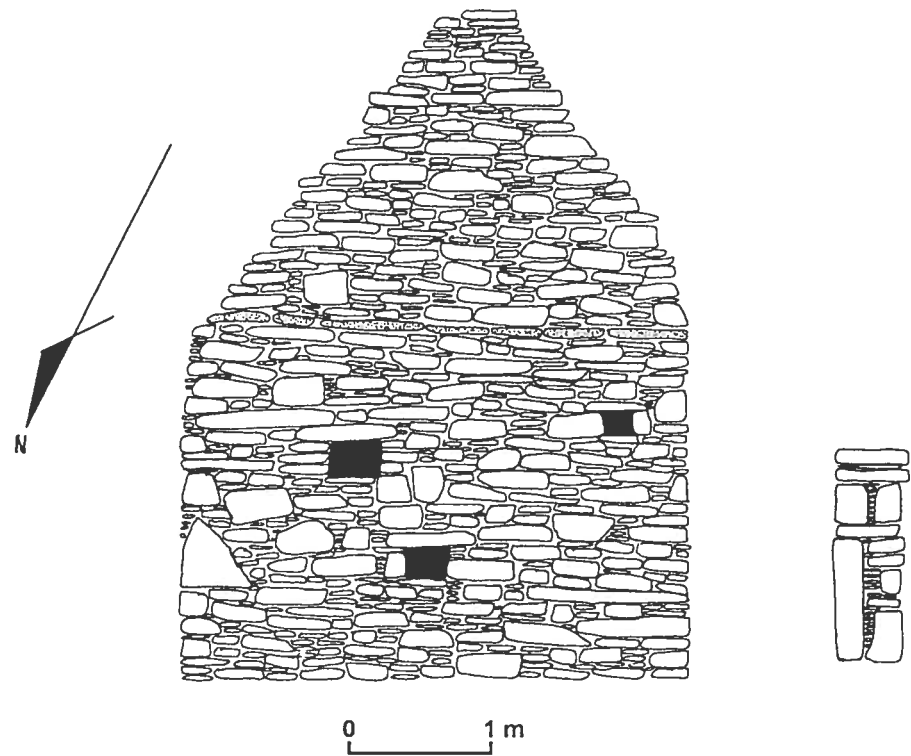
Mur arrière en pignon et profil de la porte illustrant la technique de construction par *pachillas* d'une habitation à plan simple du site # 47 (Yuying) de Yanas.
